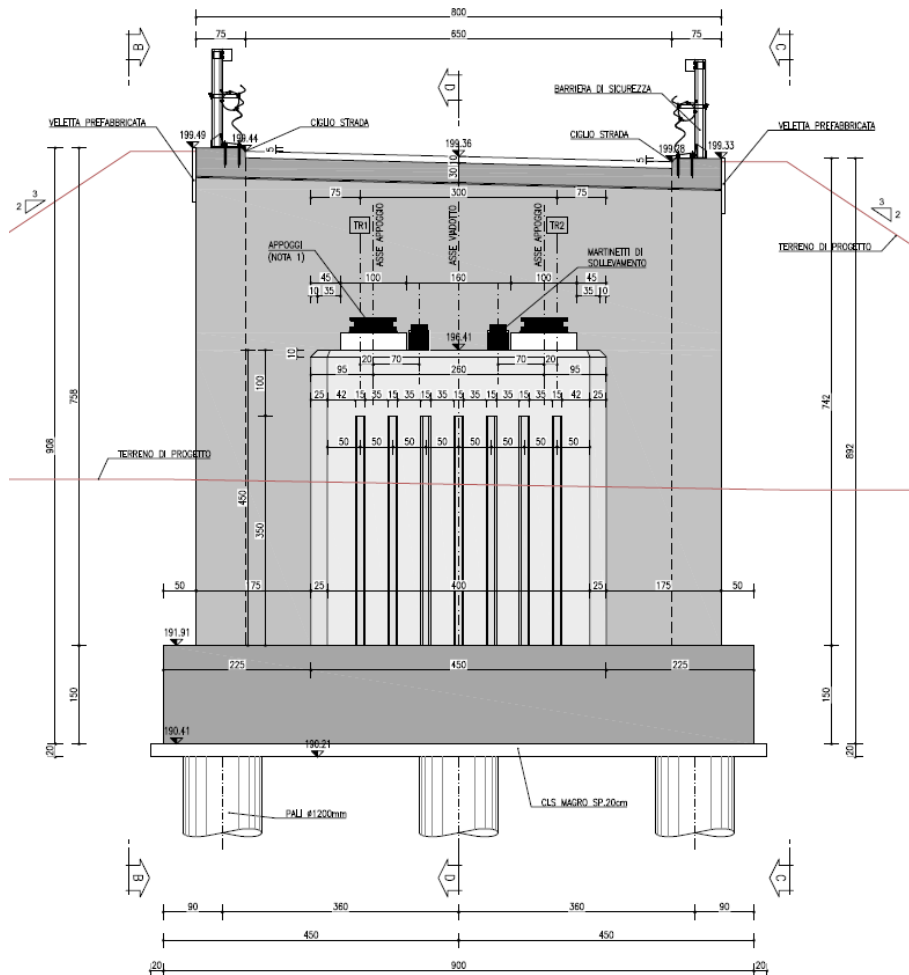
Spalla 1 – carpenteria elevazioni
